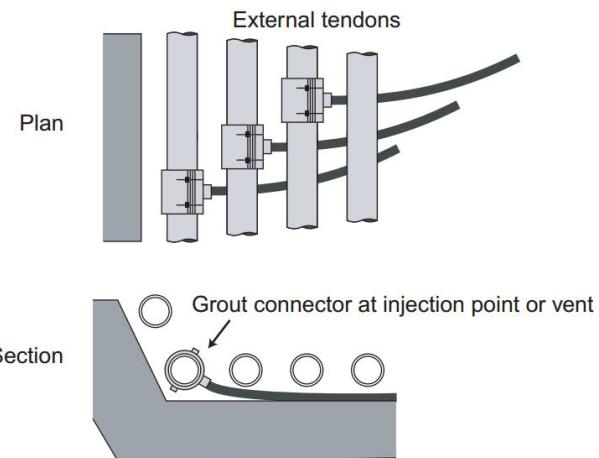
Posibles conexiones de grout para tendones externos inferiores.
